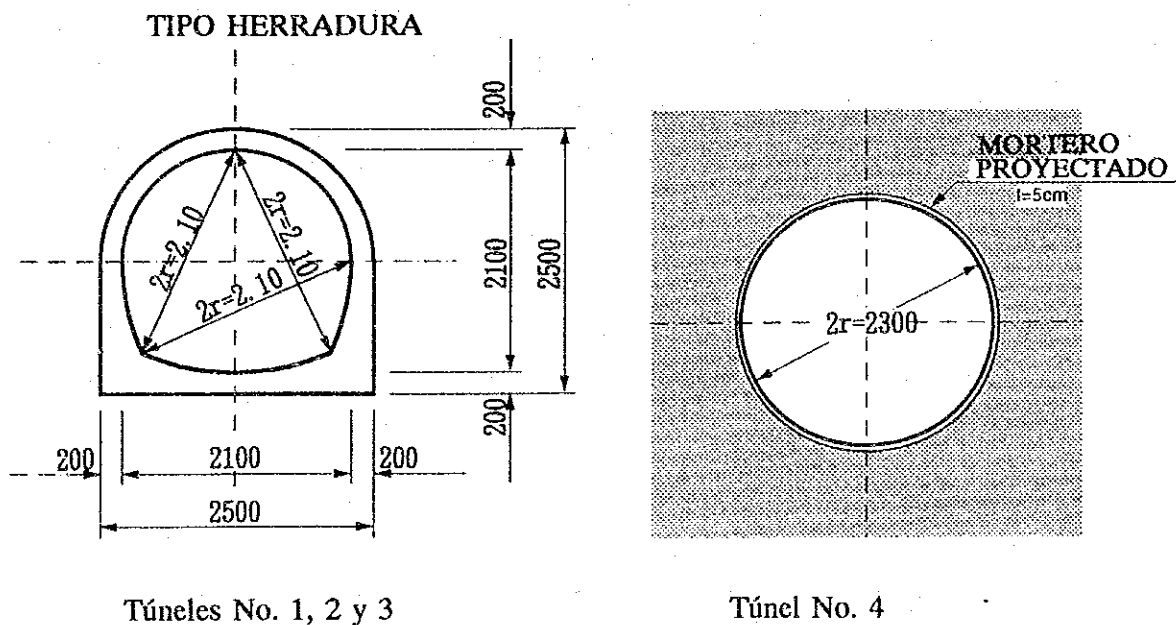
Sección Típica de Túnel del Canal de Conducción
